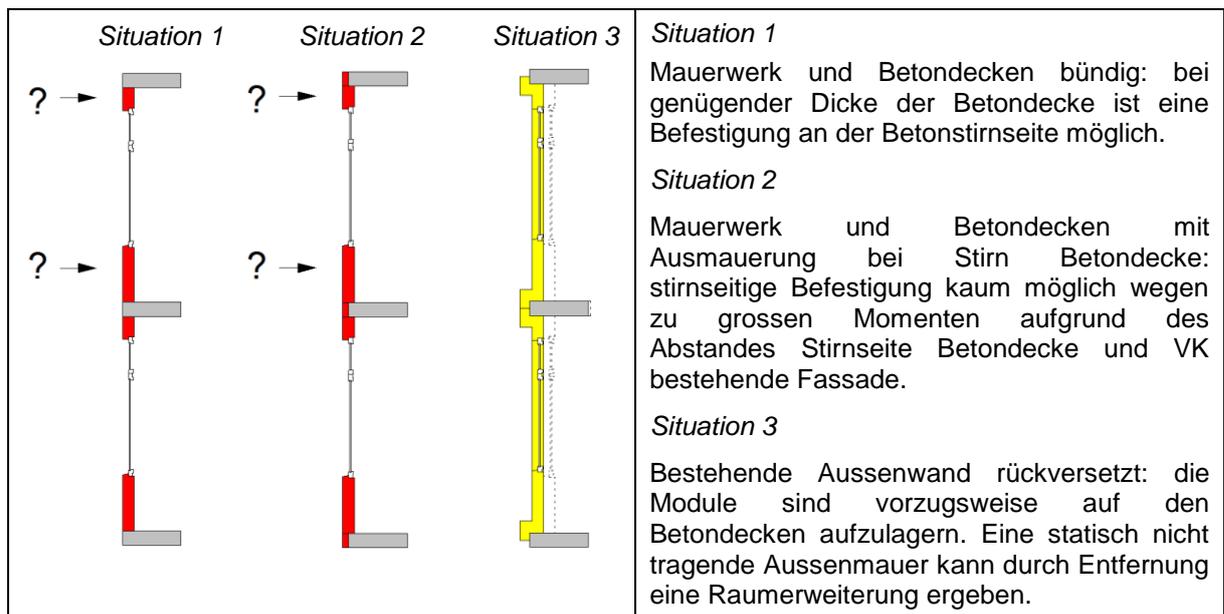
Mögliche Ausgangssituationen für statische Befestigungspunkte von Fassadenmodulen. Bestehendes Mauerwerk rot, Betondecken grau, neues Fassadenmodul gelb.
